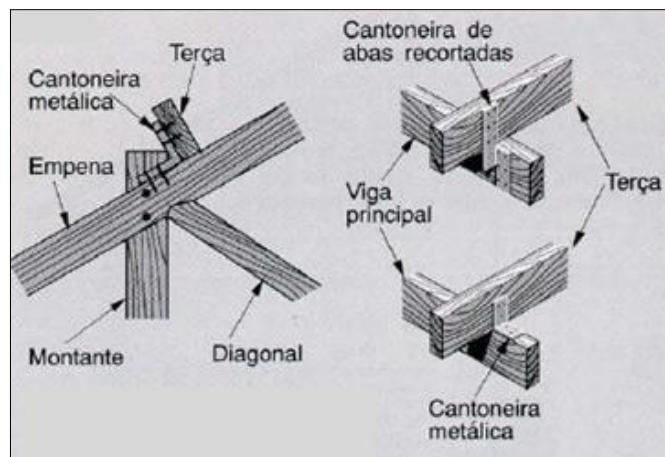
Apoio e fixação de terças de cantoneiras metálicas
